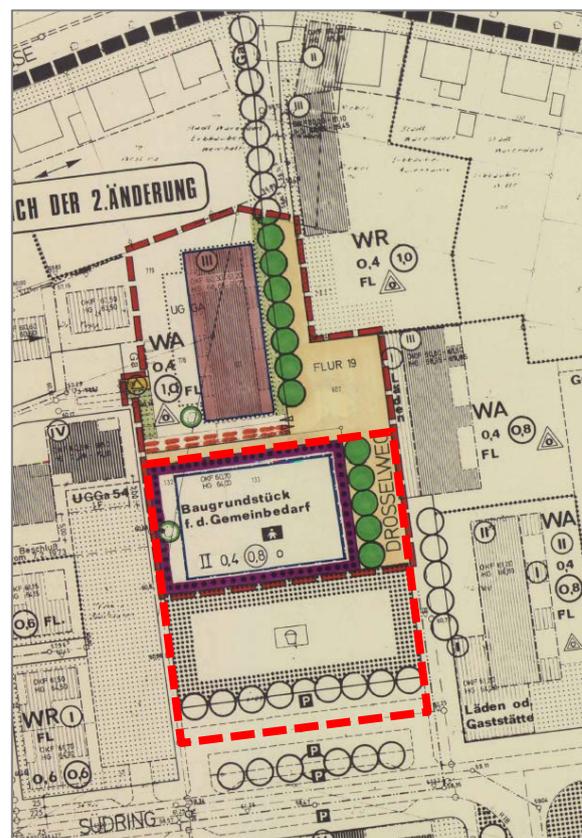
Bebauungsplan Nr. 2.27 / 2. Änderung
